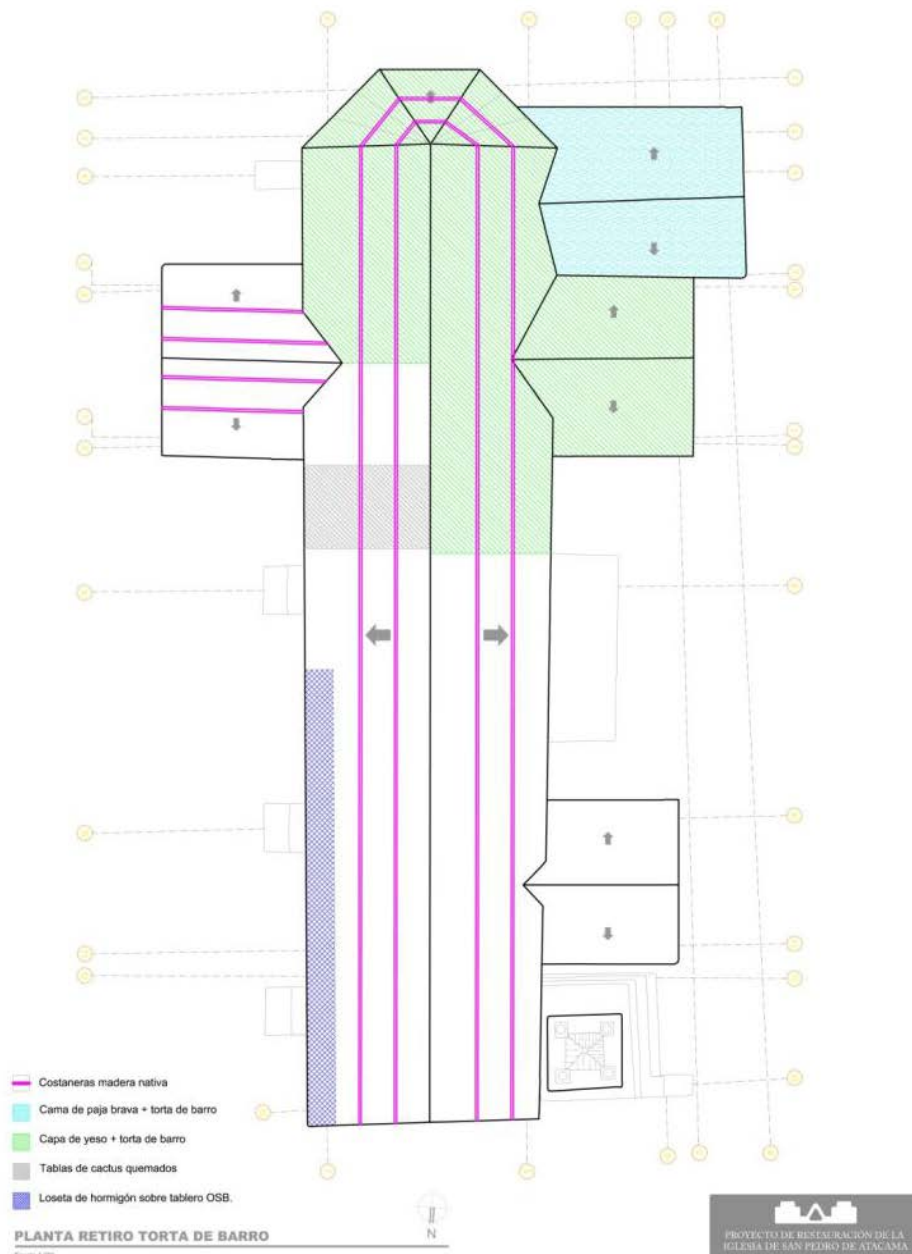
Planta de situación de la techumbre al retirar la torta de barro existente
